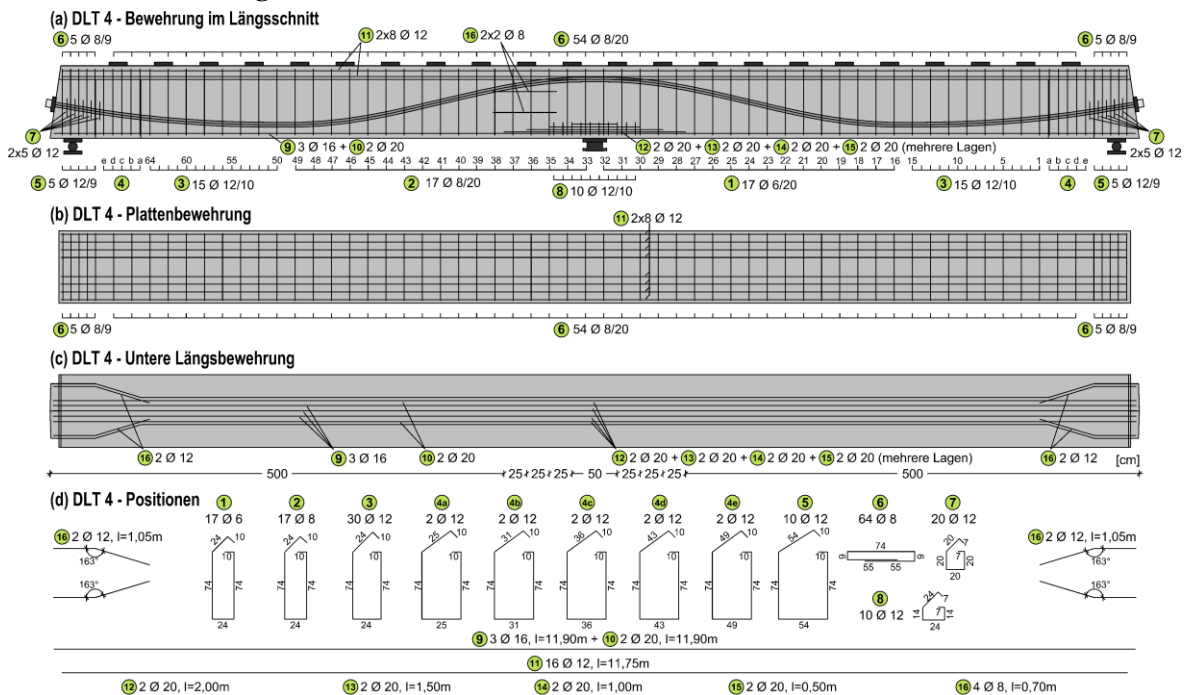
Bewehrungsplan Versuchsträger DLT 4
